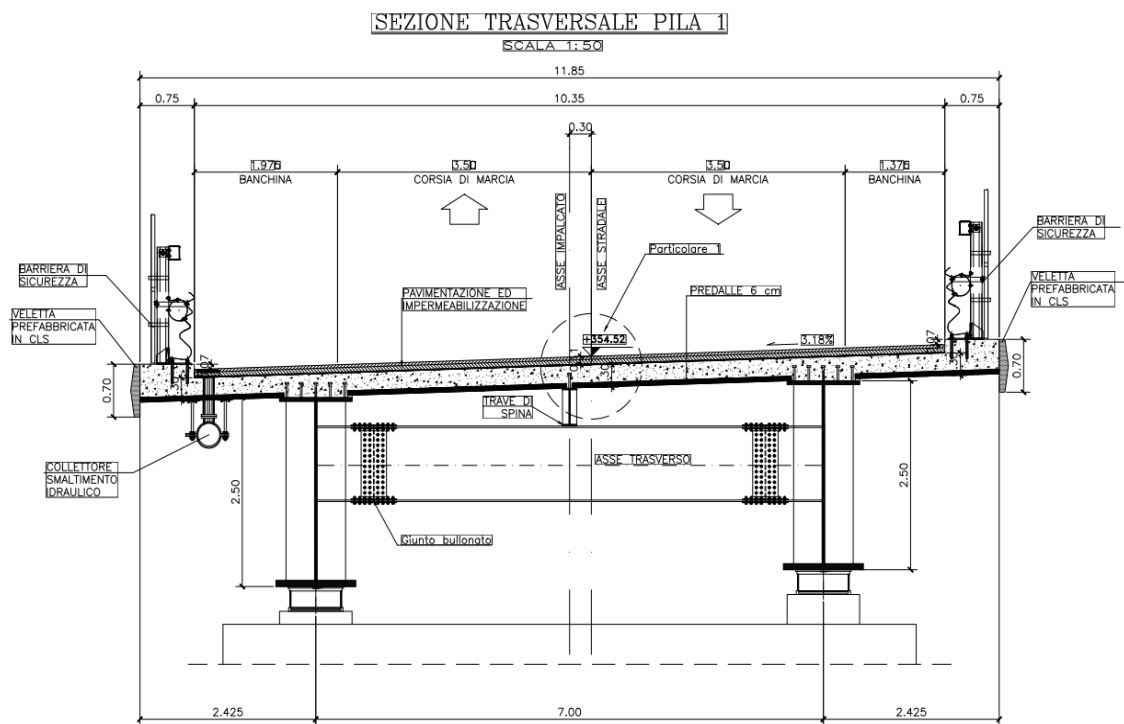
Sezione trasversale dell'impalcato - sezione su pila tipo (sezione tipo1)
